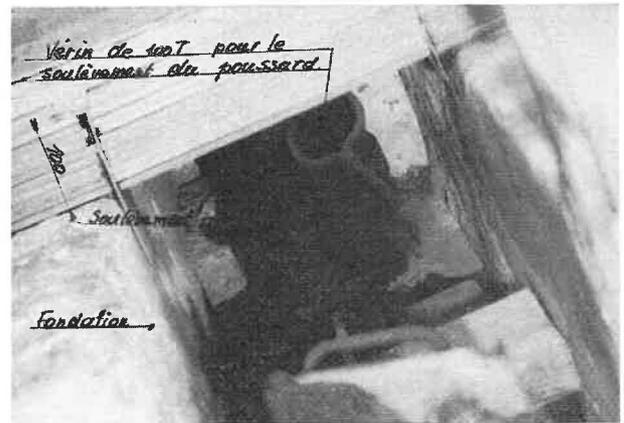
Installation d'un vérin de 100 t sous la base du poussard en vue du soulèvement. Cette photo a été prise après le soulèvement et on remarque les épaisseurs placées sous le pied.
